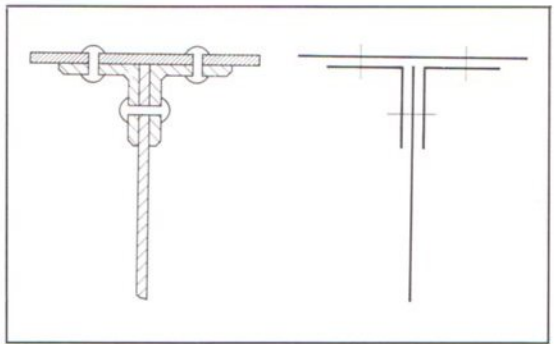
Schnittzeichnung eines T-Trägers mit zusätzlich angebrachter Gurtplatte.
